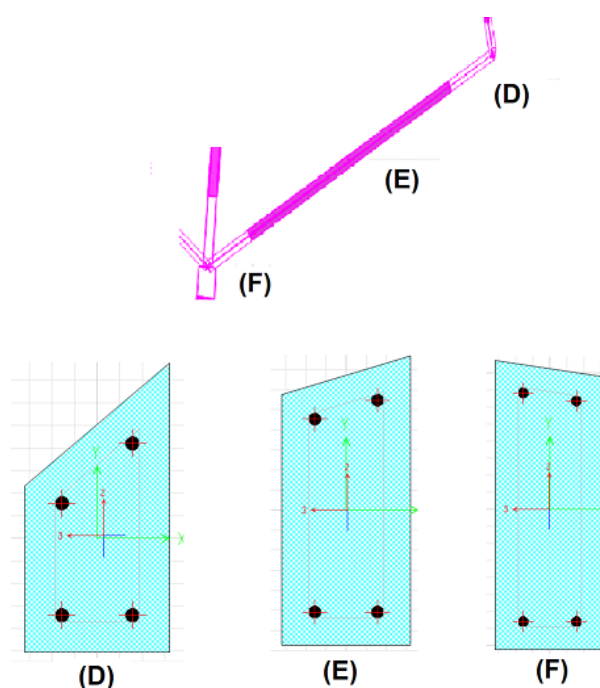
Secciones en el elemento 03 viga inclinada desde la intersección con las columnas inclinadas hasta la unión entre vigas inclinadas (D) 0.20m x 0.23m x 0.4m, (E) 0.20m x 0.39m x 0.45 m y (F) 0.20m x 0.50m x 0.53m.
